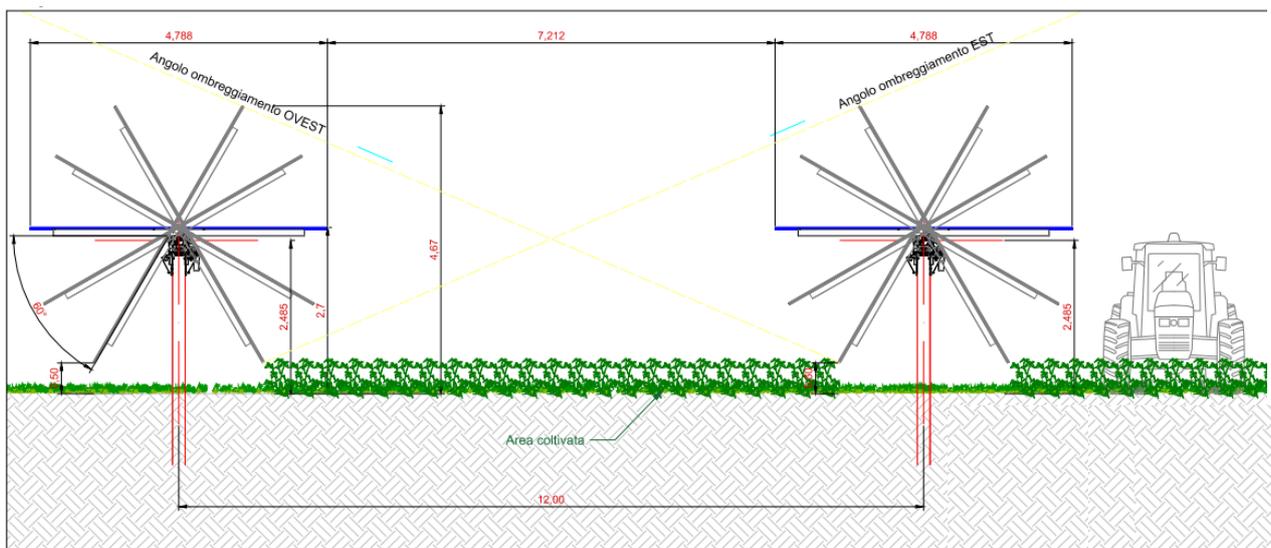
Rappresentazione spazio interfilare e altezza pannelli
